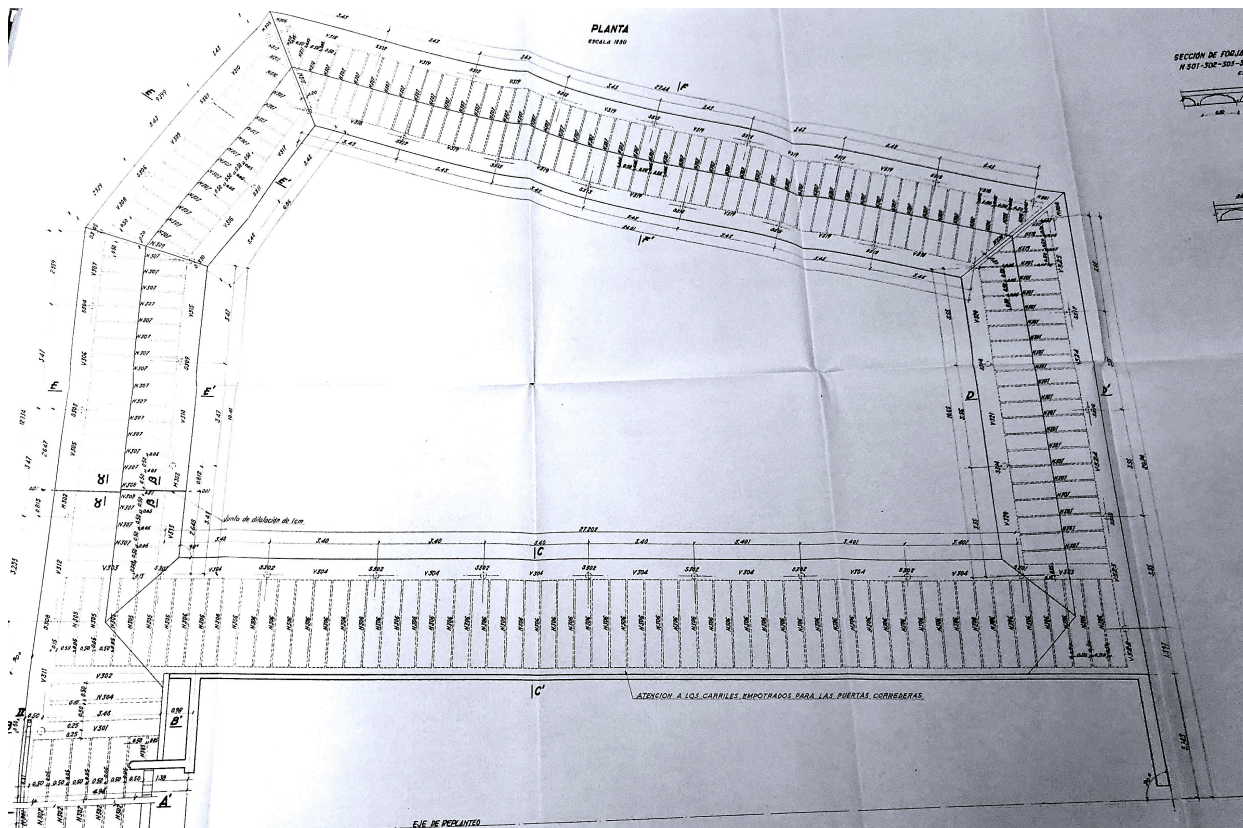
, Planta de la estructura de la Casa Abadía)
